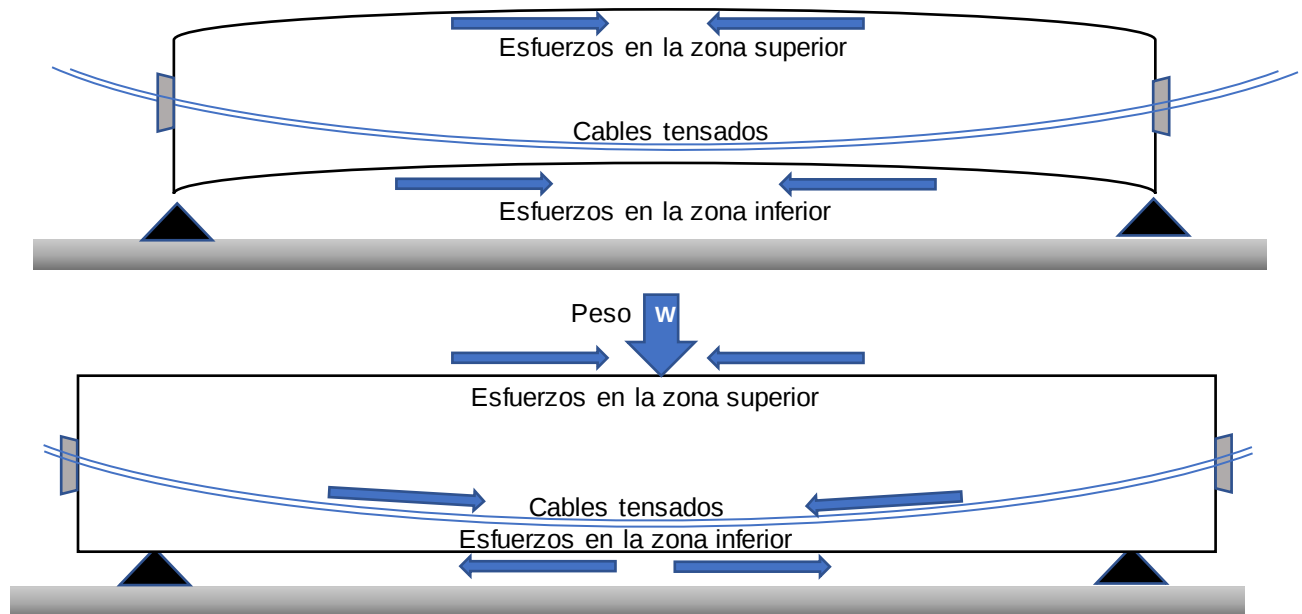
Las fuerzas que actúan comprimiendo la zona inferior.
